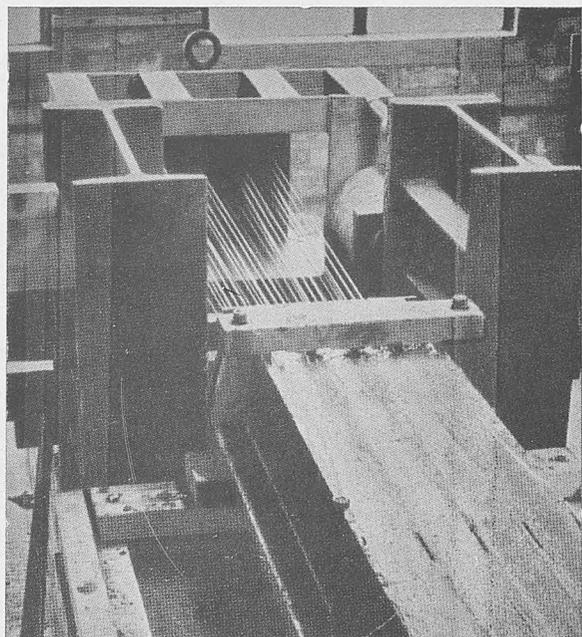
Tzado de alambres en la fabricación de viguetas.
